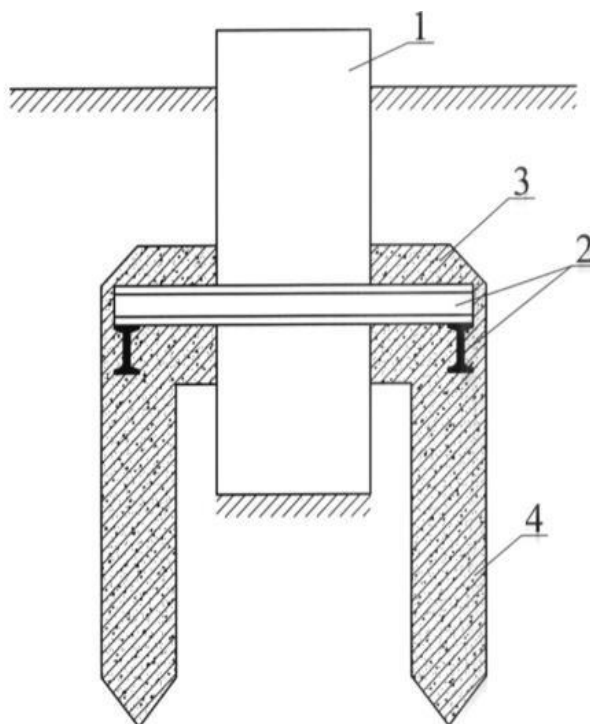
Усиление ленточного фундамента передачей нагрузки на выносные опоры:
